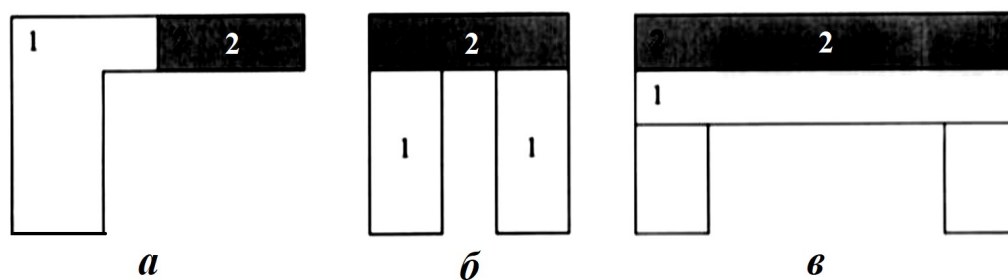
Варіанти прибудови та вбудови: а - в торець будівлі; б- між двома будівлями; в - збоку будівлі; 1- існуюча будівля; 2 - прибудова (вбудова).
